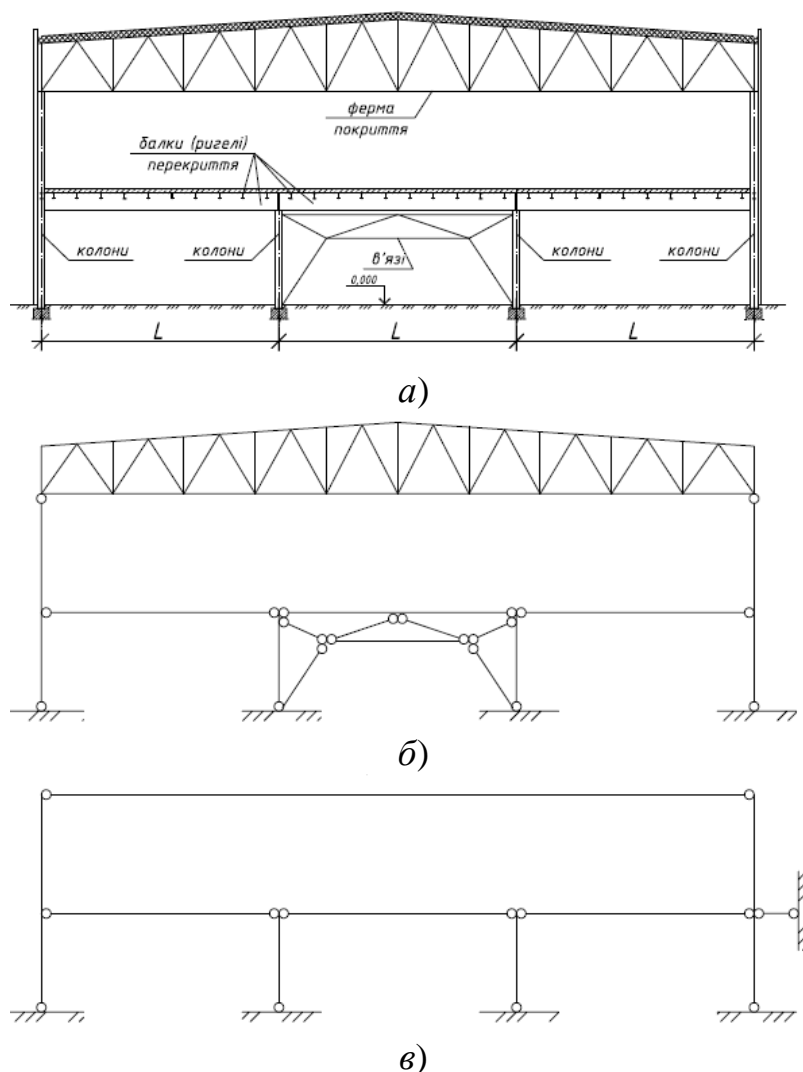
Конструктивна та розрахункова схема будівлі:
